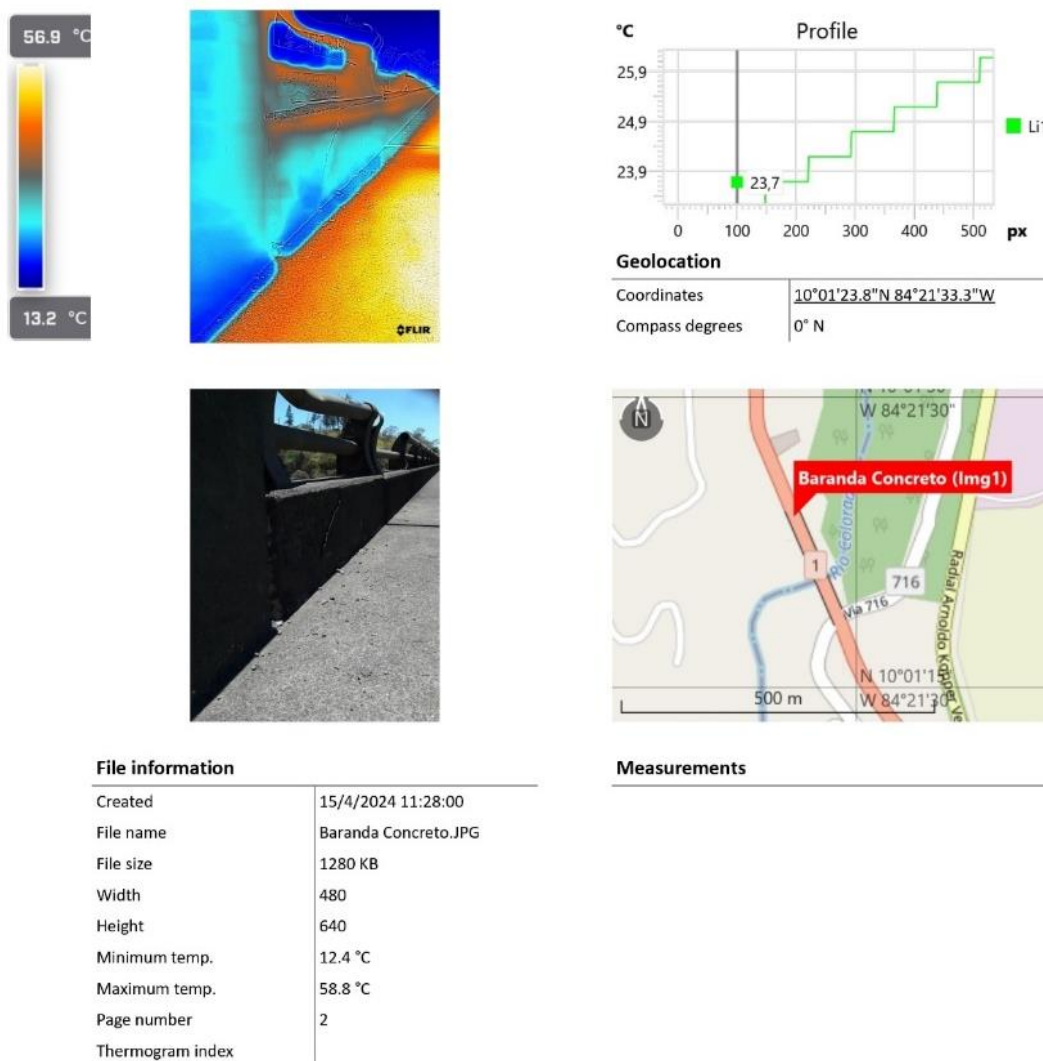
27 Reporte térmico delaminaciones en las barandas de la sección No. 8
